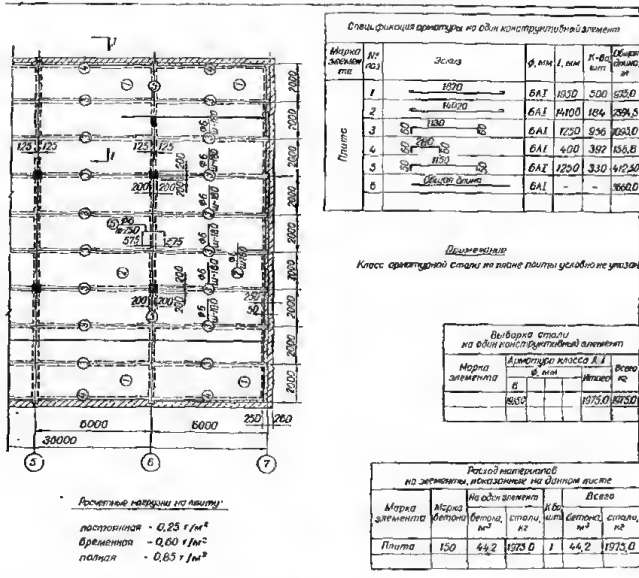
Раздельное армирование плиты ребристого перекрытия отдельными стержнями.
